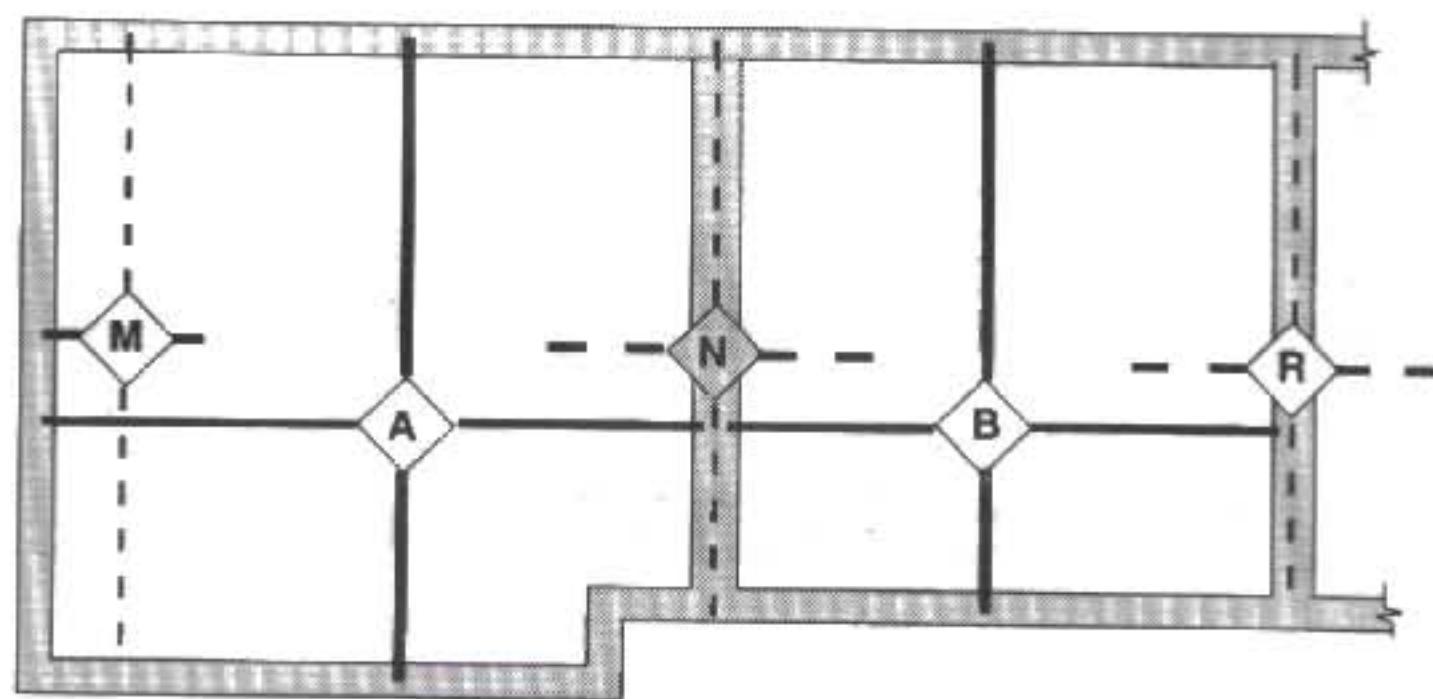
Représentation: dalles armées de panneaux treillis soudés 2^{ème} moyen
